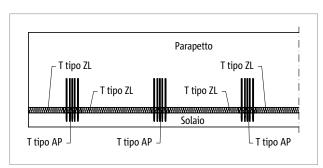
Schöck Isokorb® T tipo AP: disposizione verticale, parapetto sovrapnosto
